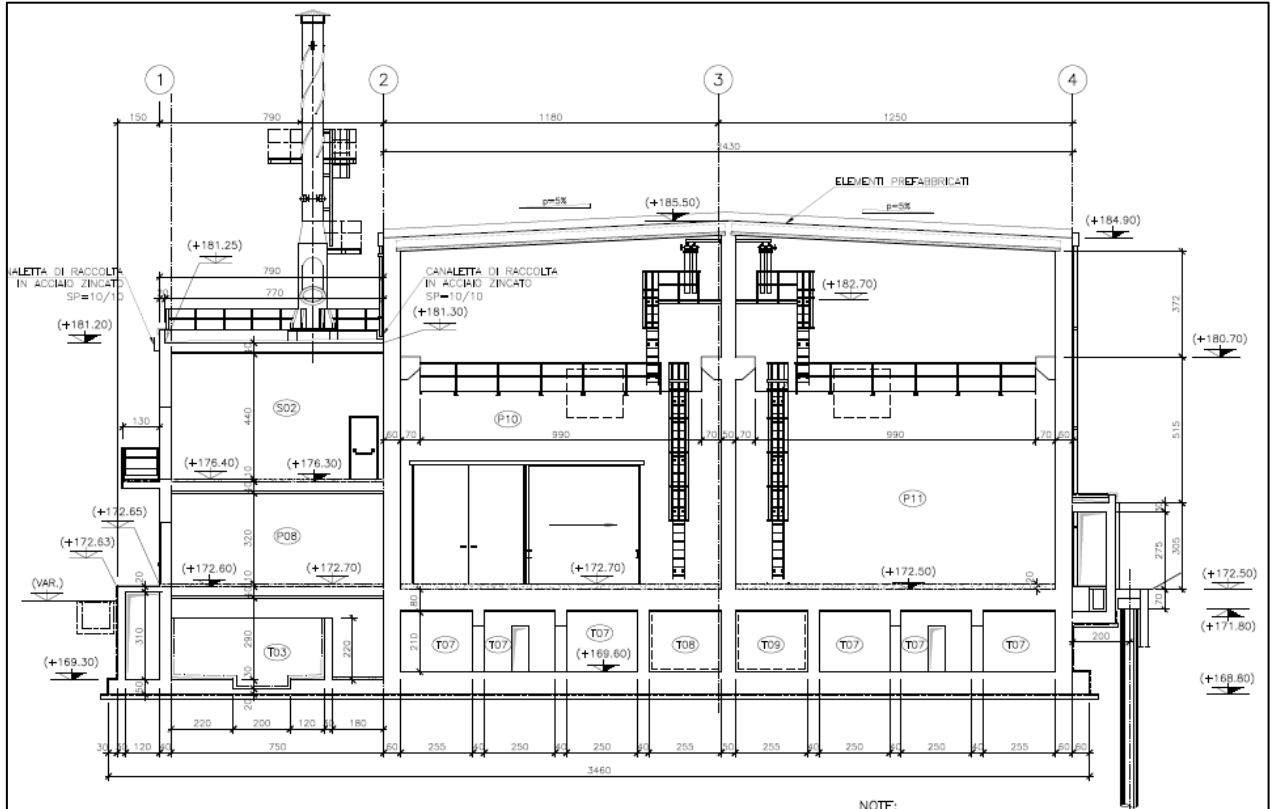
Nuovo deposito 2300: sezione tipica trasversale
